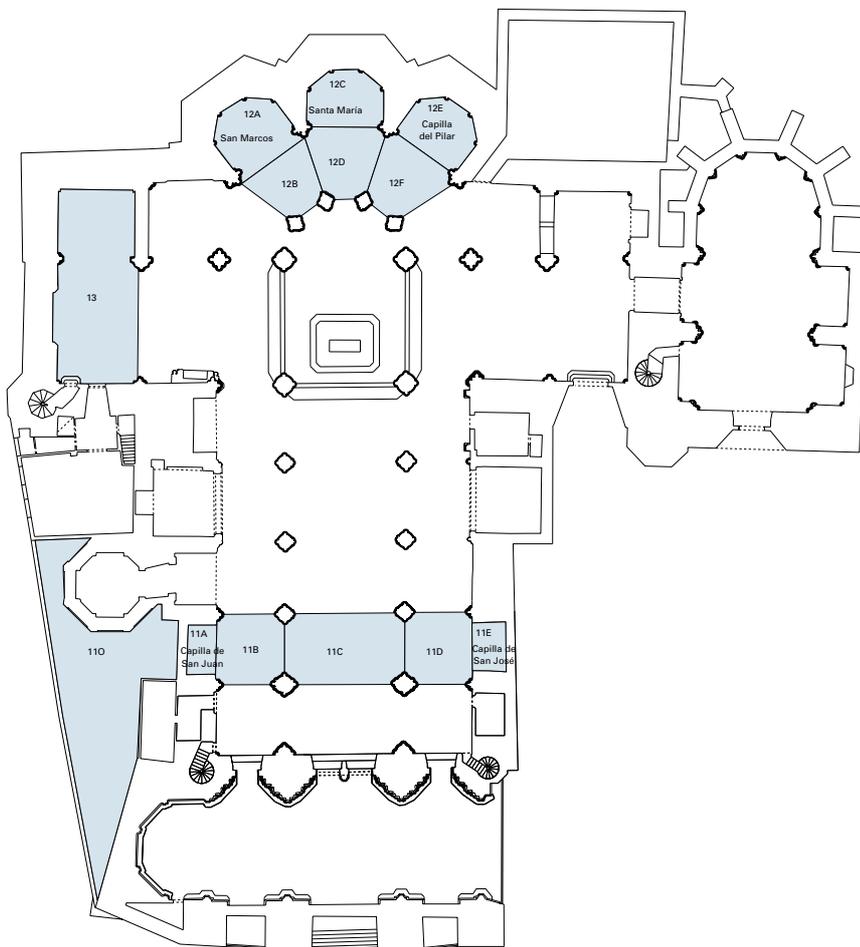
Planta de la Catedral de Santa María donde se señalan las zonas excavadas durante la realización del Plan Director
